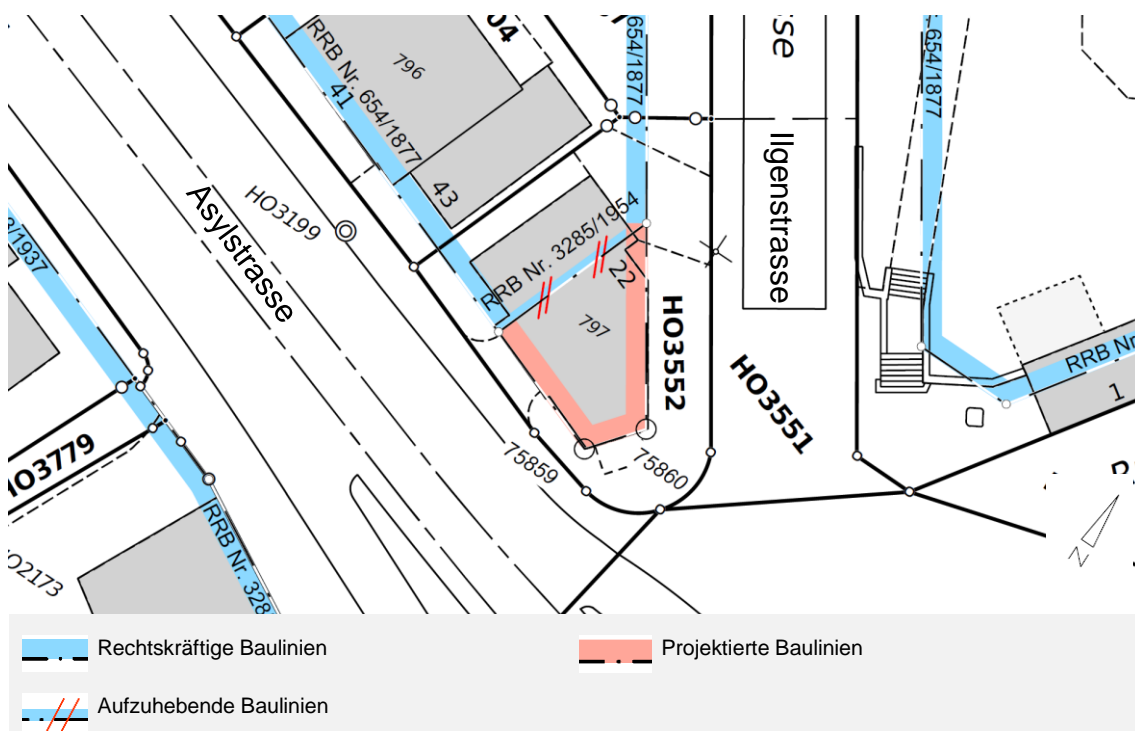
Ausschnitt Baulinienvorlage Römerhofplatz, Plan Nr. 2020-19
